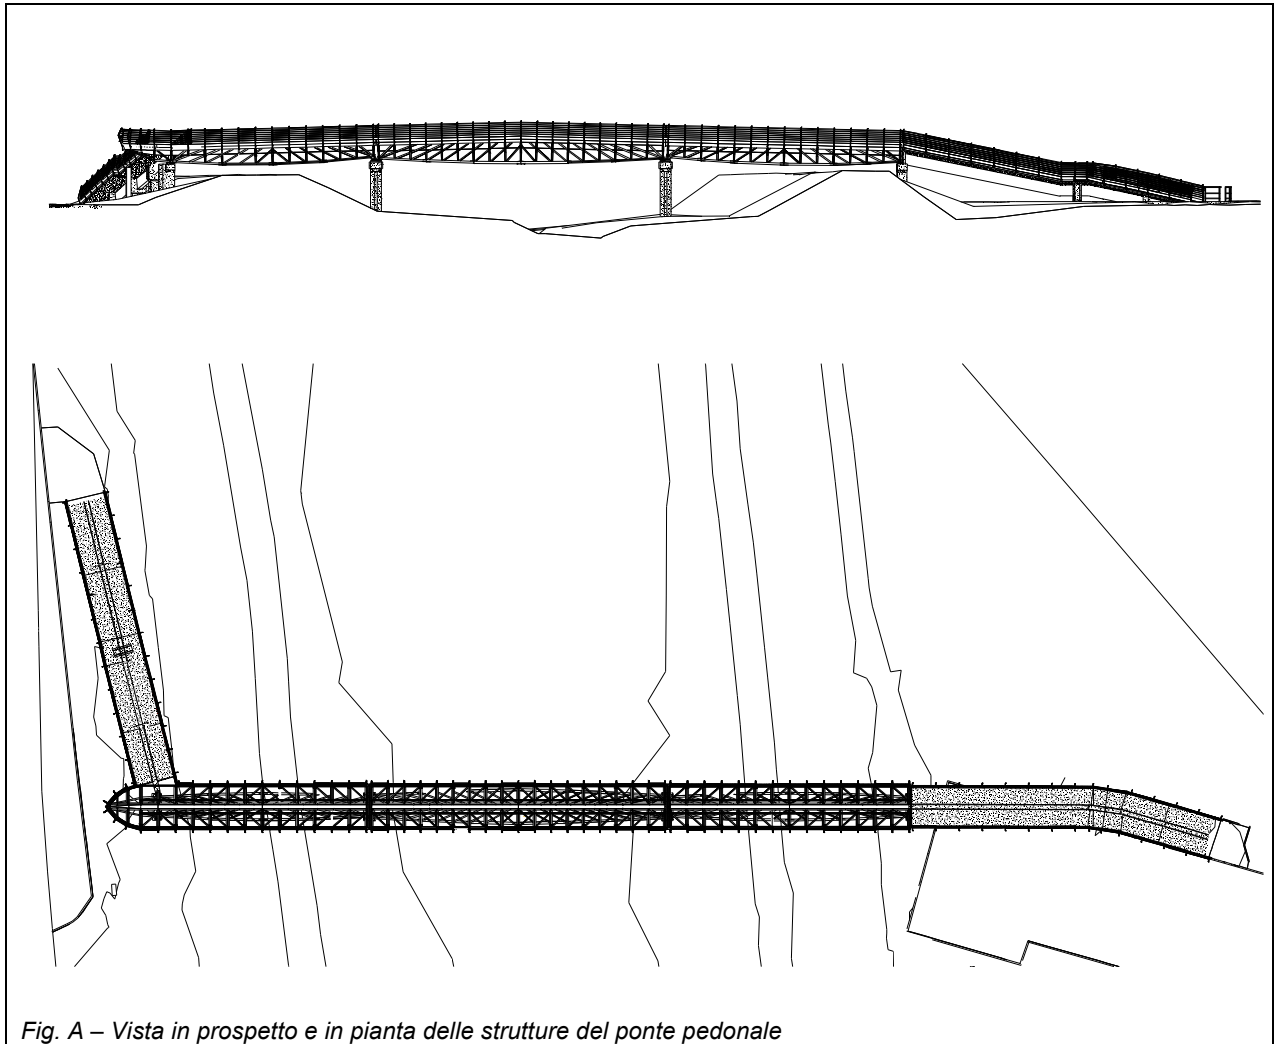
Fig. A – Vista in prospettiva e in pianta delle strutture del ponte pedonale
